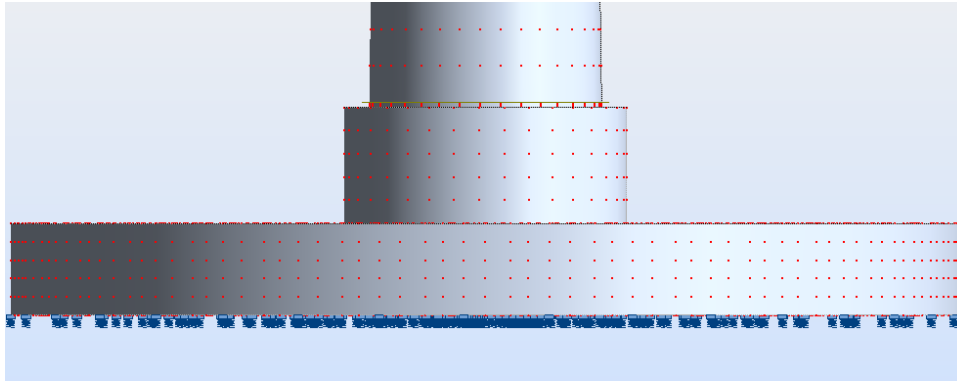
Pormenor da laje e do pedestal da sapata
